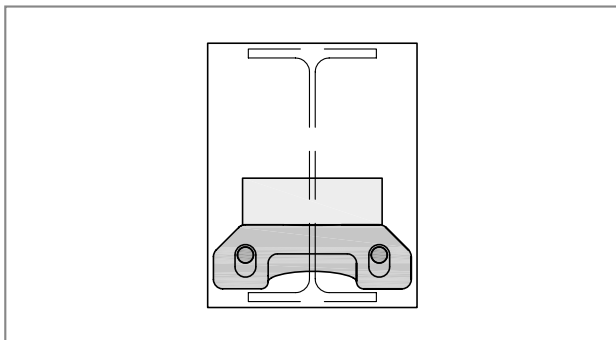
Schöck Isokorf® T type SQ: verdraaide en verschoven elementen door onvoldoende fixatie tijdens het beton storten
